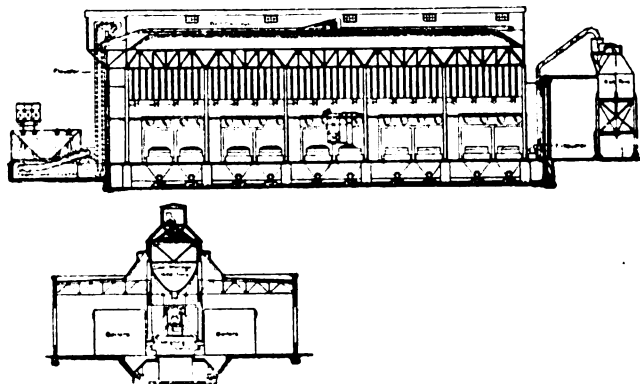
Centrale di Riverside and Dan River Cotton Mills, Danville.
